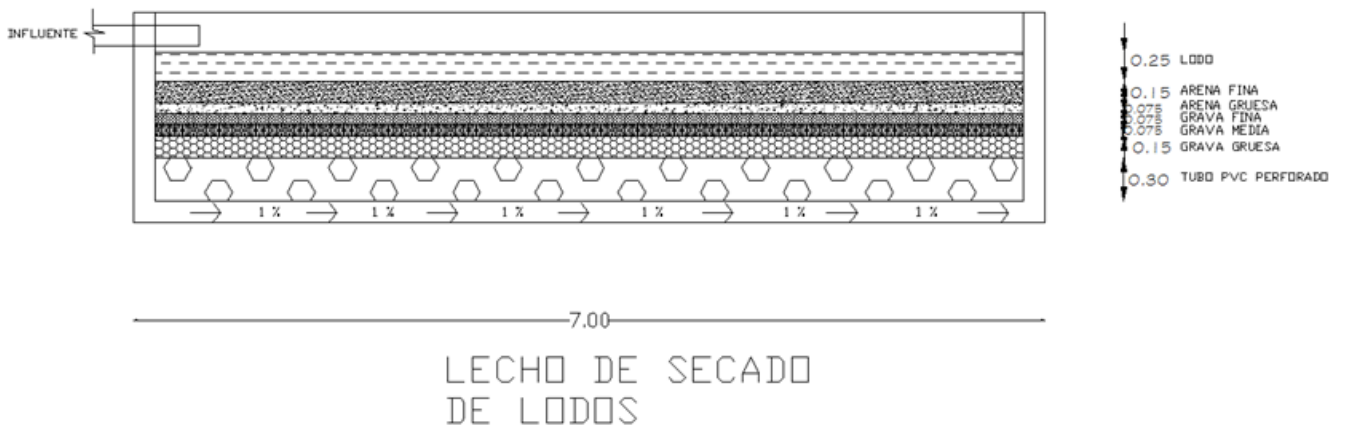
b) Vista en corte de lecho de secado de lodos
